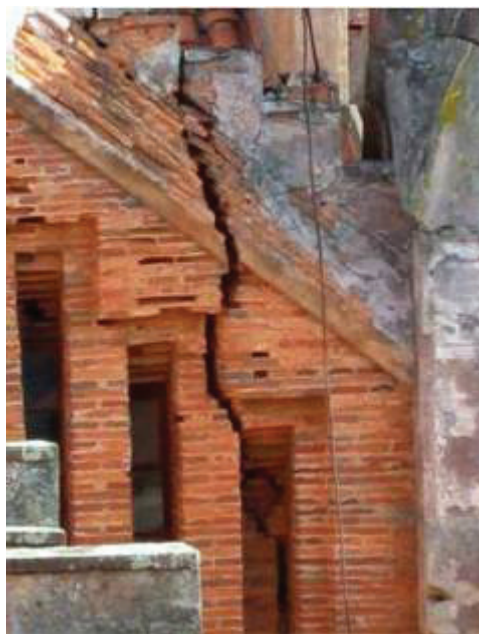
Agrietamiento importante (apertura de 6 cm) en un muro de arriostramiento de un edificio del siglo XIX.
